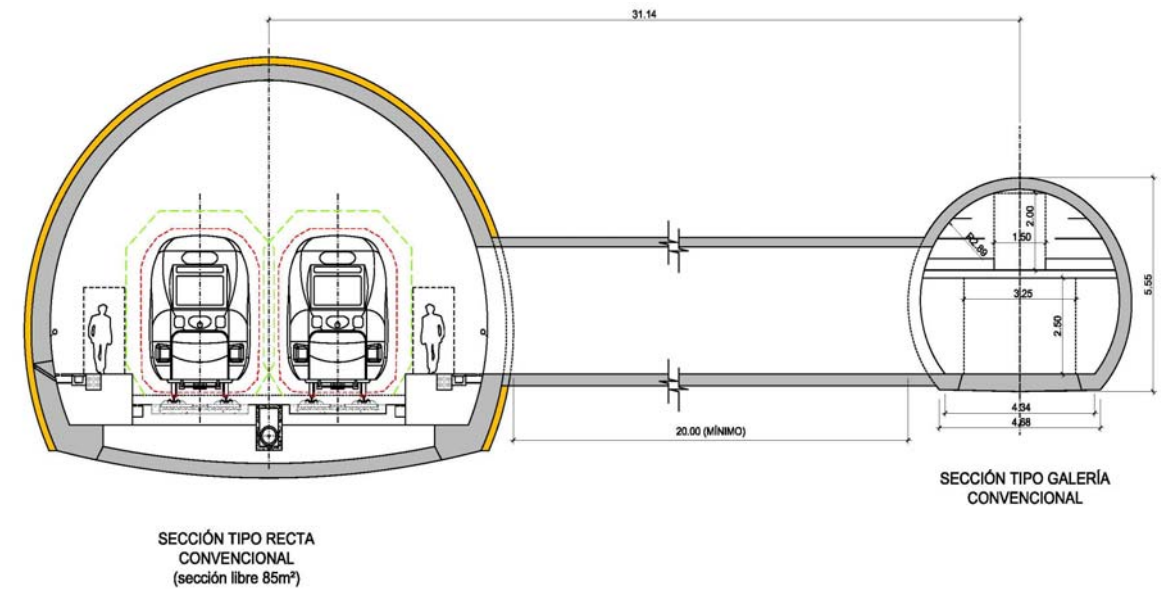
Sección tipo Túnel con tuneladora y galería de servicios y evacuación
